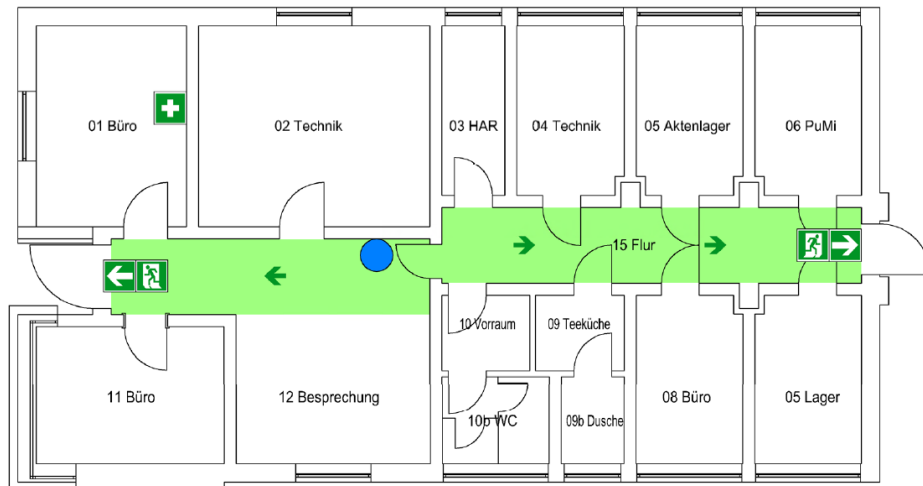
Grundrissplan EG, Gebäude FB
